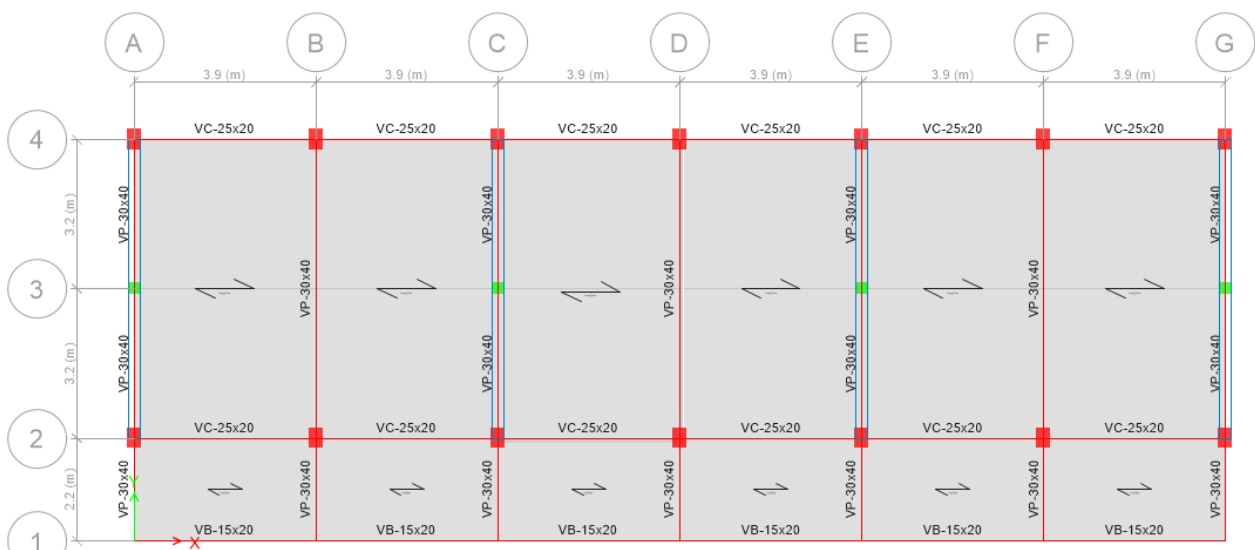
Vista en planta con sus dimensiones del pabellón 4.
